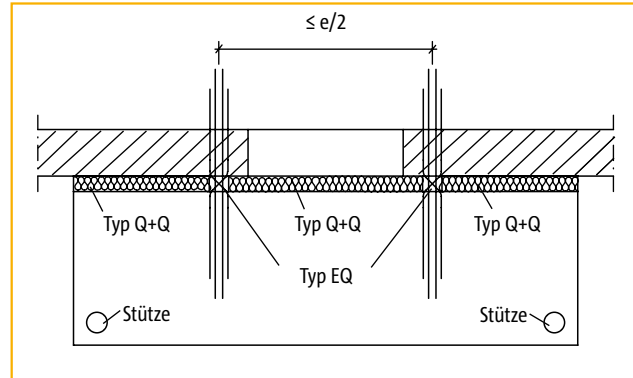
Grundriss Balkon gestützt + Typ Q+Q + Typ EQ
